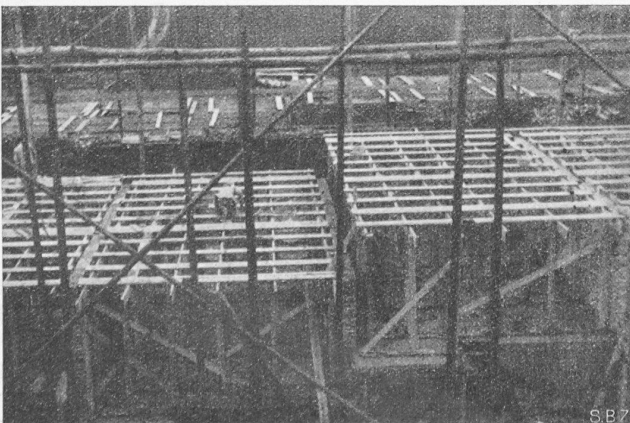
Deckenschalung über den tragenden Quermauern, Deckenrippen parallel zur Längsrichtung der Blöcke.
